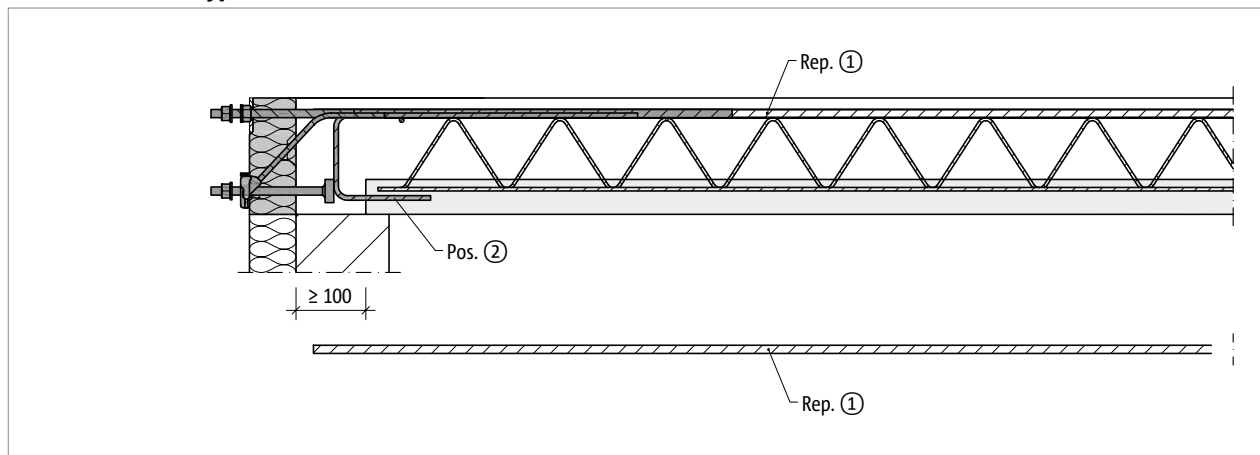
Schöck Isokorb® T type SK-M1 : renforcement sur site pour construction semi-préfabriquée, coupe
